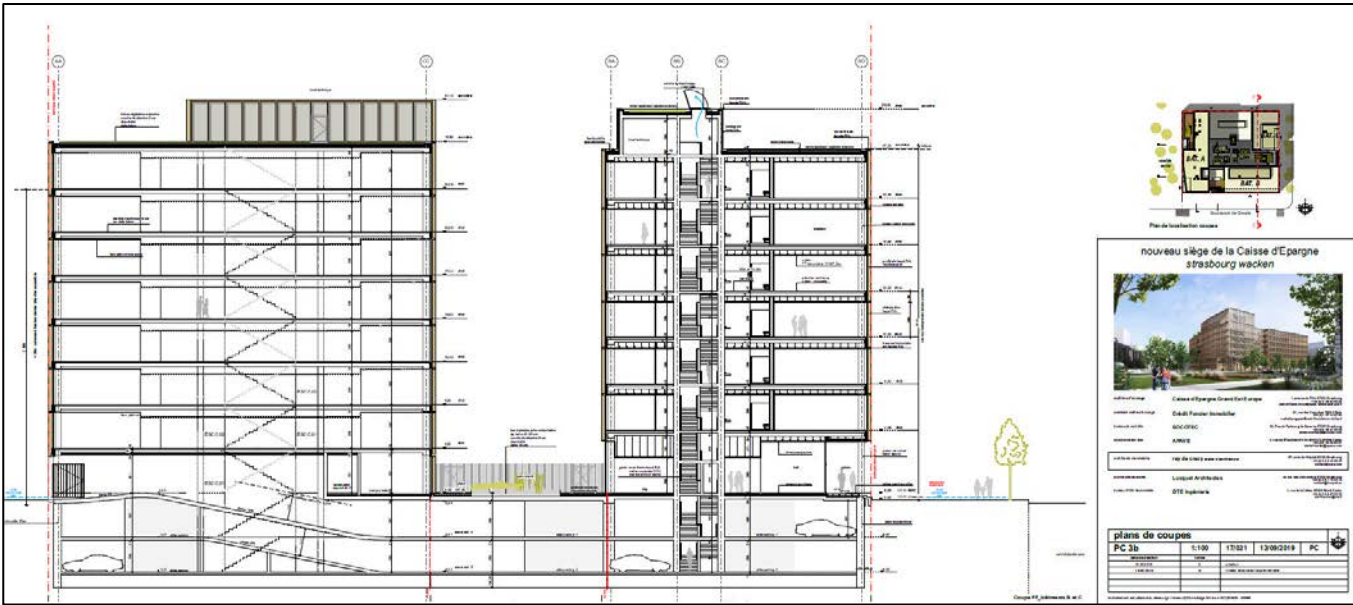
Plan en coupe des bâtiments B et C et des niveaux souterrains
